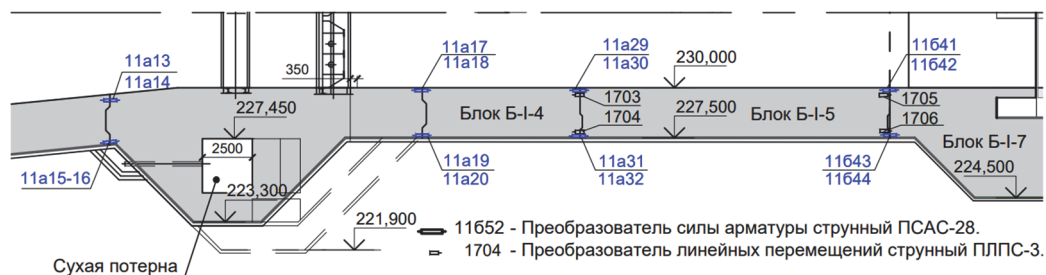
Схема размещения КИА в фундаментной плите с указанием номеров блоков бетонирования
